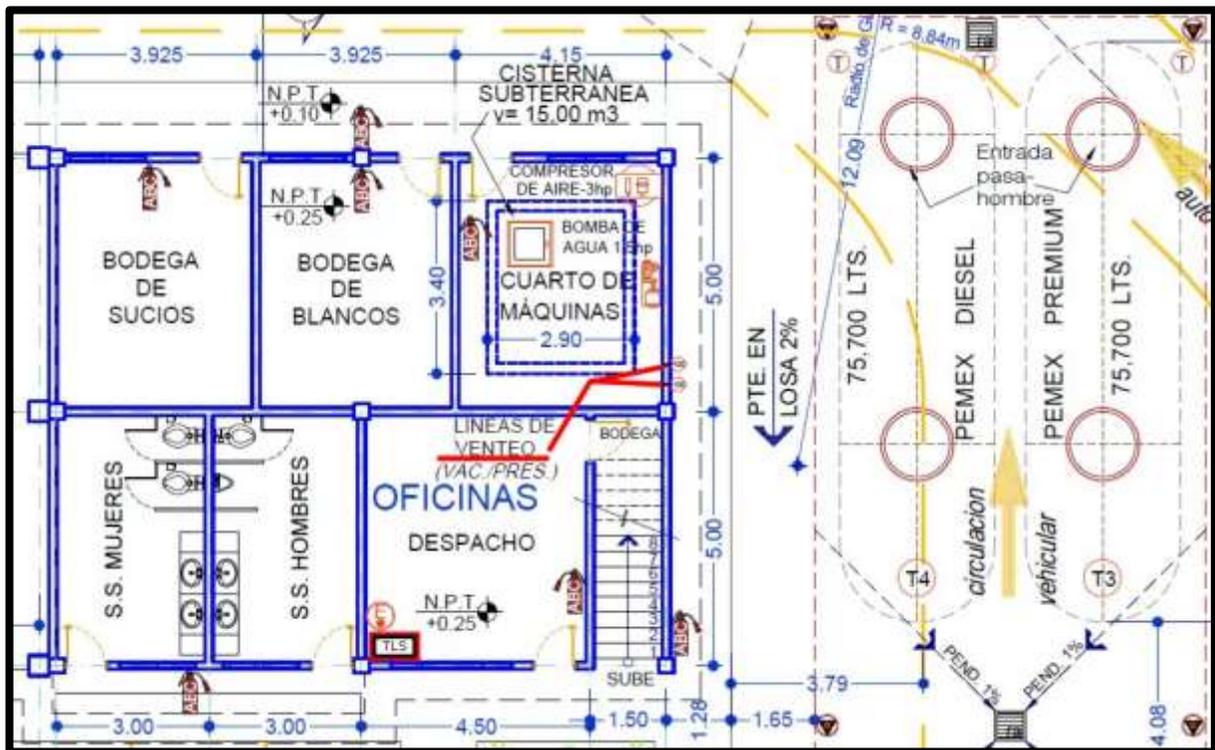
Ubicación de la tubería de venteo (Plano A-1.1).
